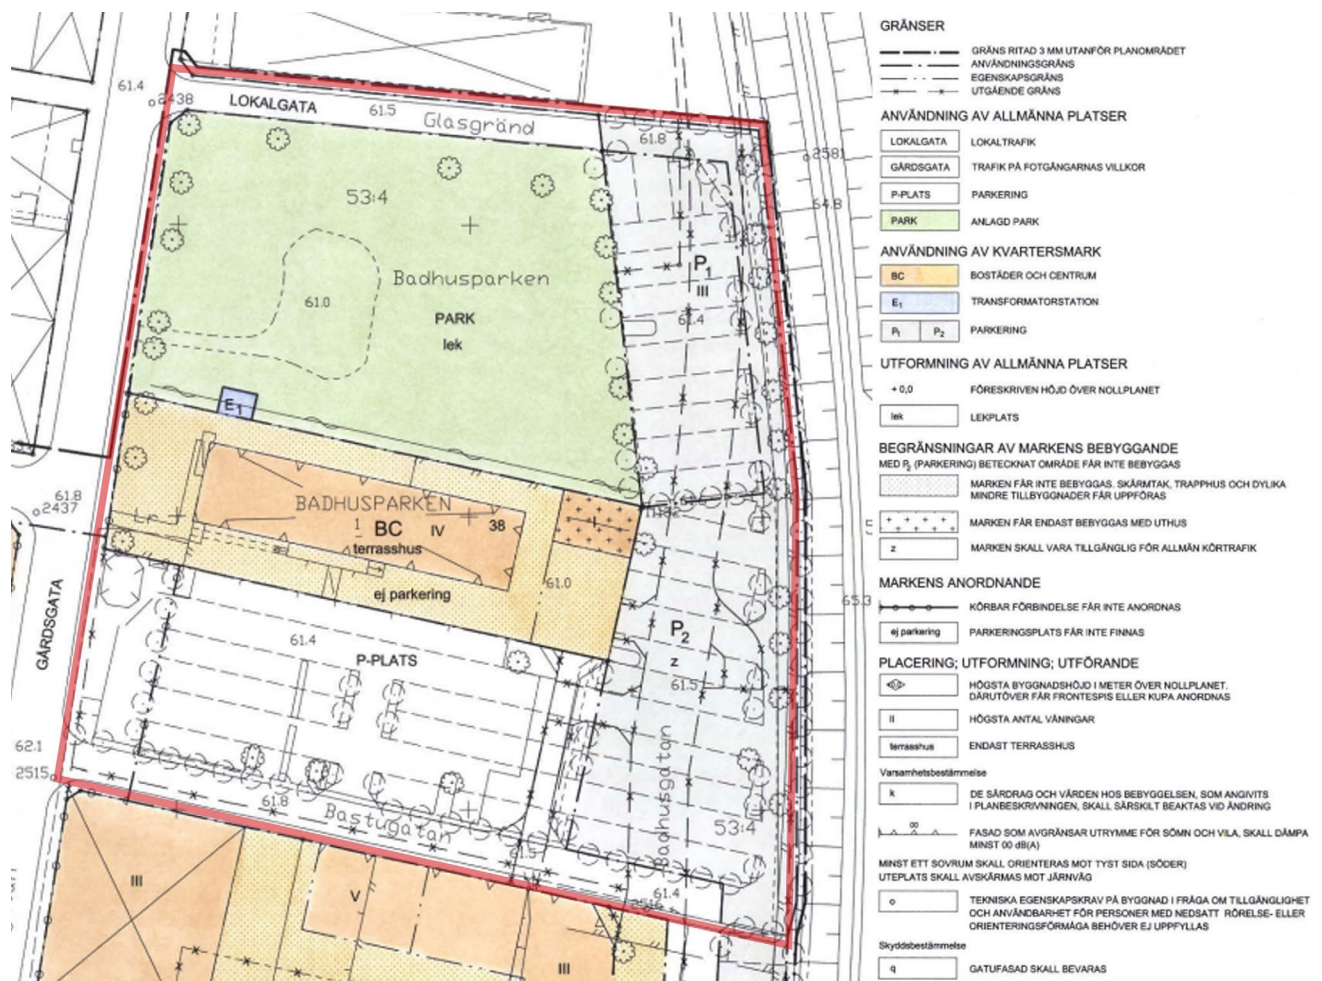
Utsnitt från gällande detaljplan E.257 – *Detaljplan för bostäder och centrumverksamheter norr om Stora torg*, från 2000-05-02.
